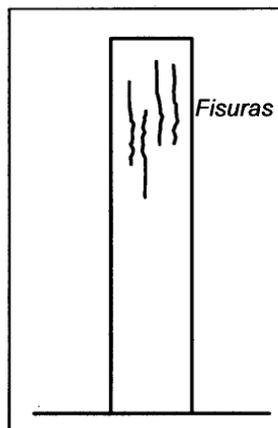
Fisuración longitudinal en columnas por compresión
